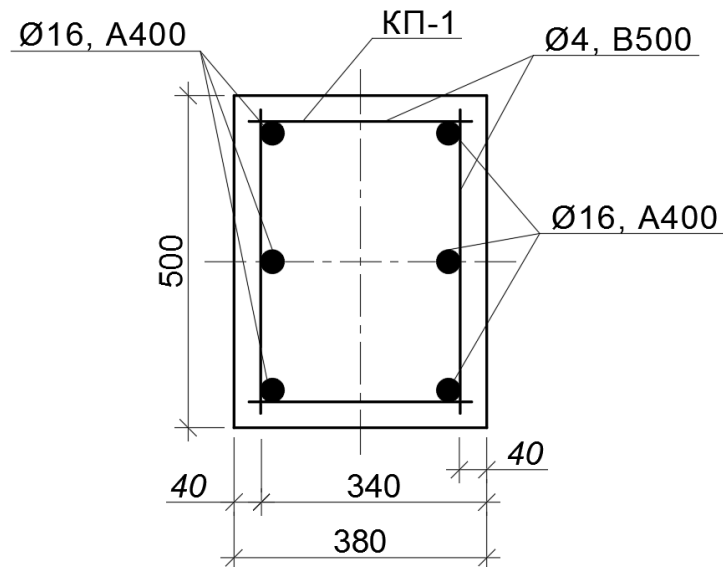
Схема армирования сечения надкрановой части колонны (1-0)
